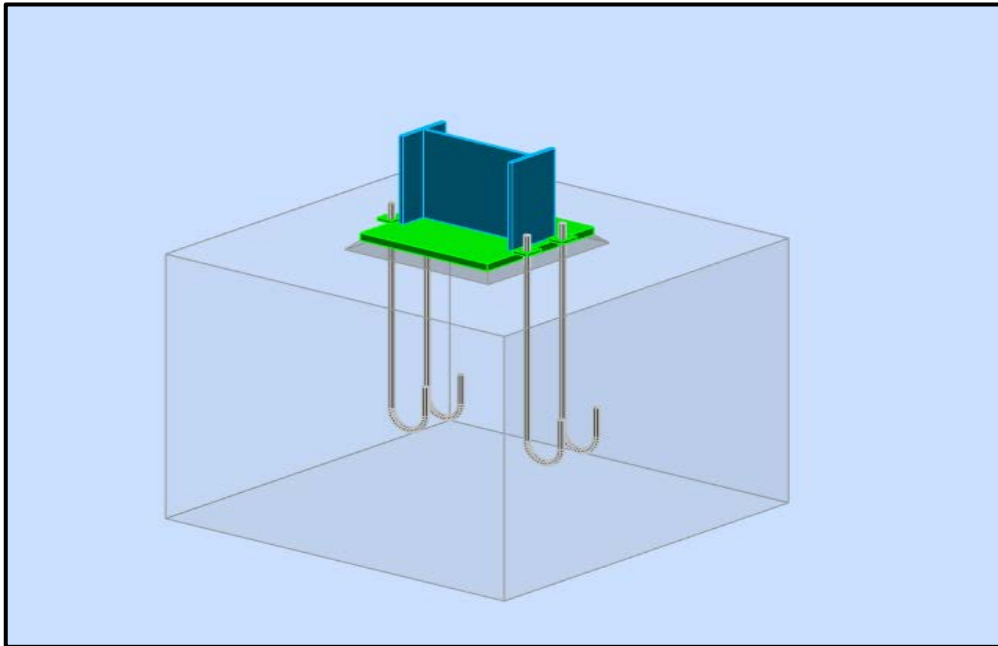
Vue en 3D l'assemblage pied de poteau
